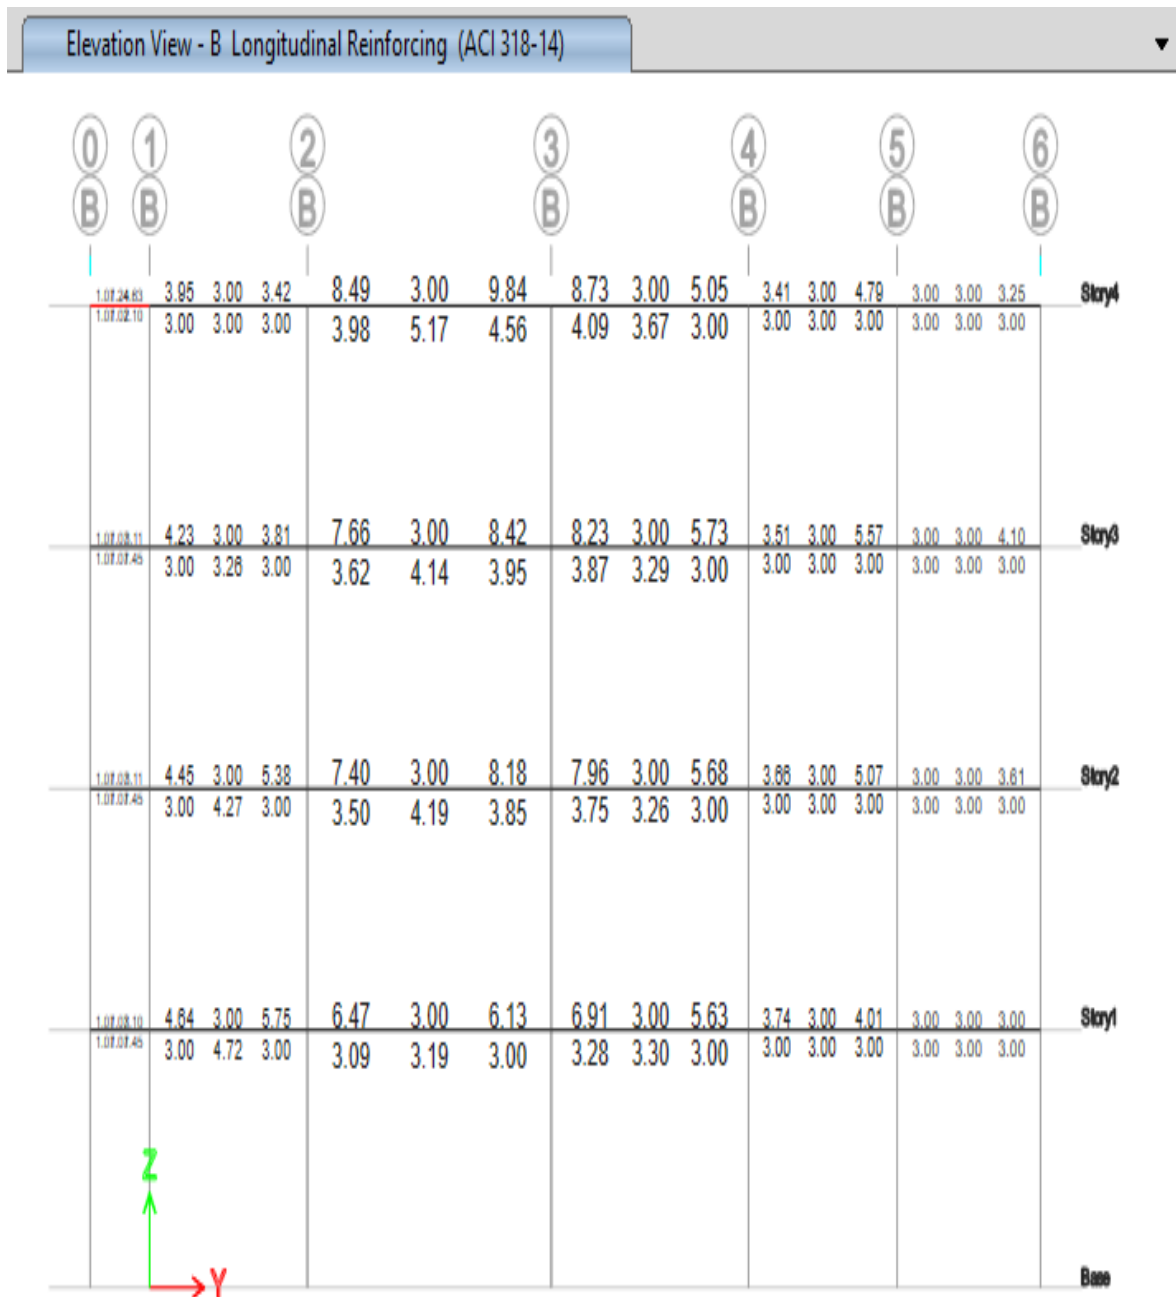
Area de Acero Requerido en Vigas utilizando Etabs
